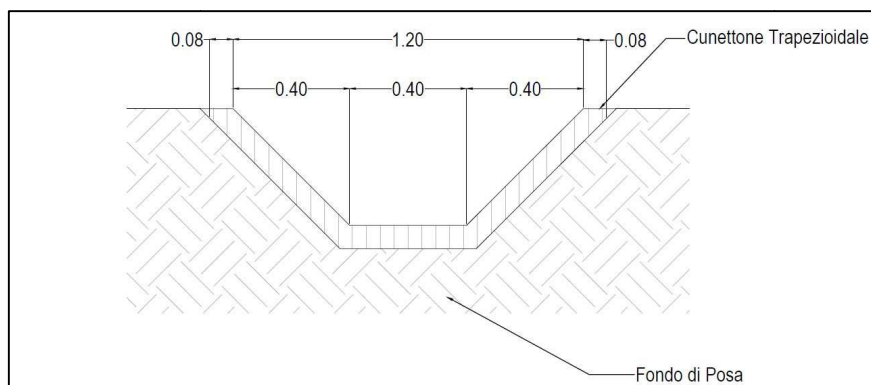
CUNETTORE trapezoidale prefabbricato 40 x 40 x 40
